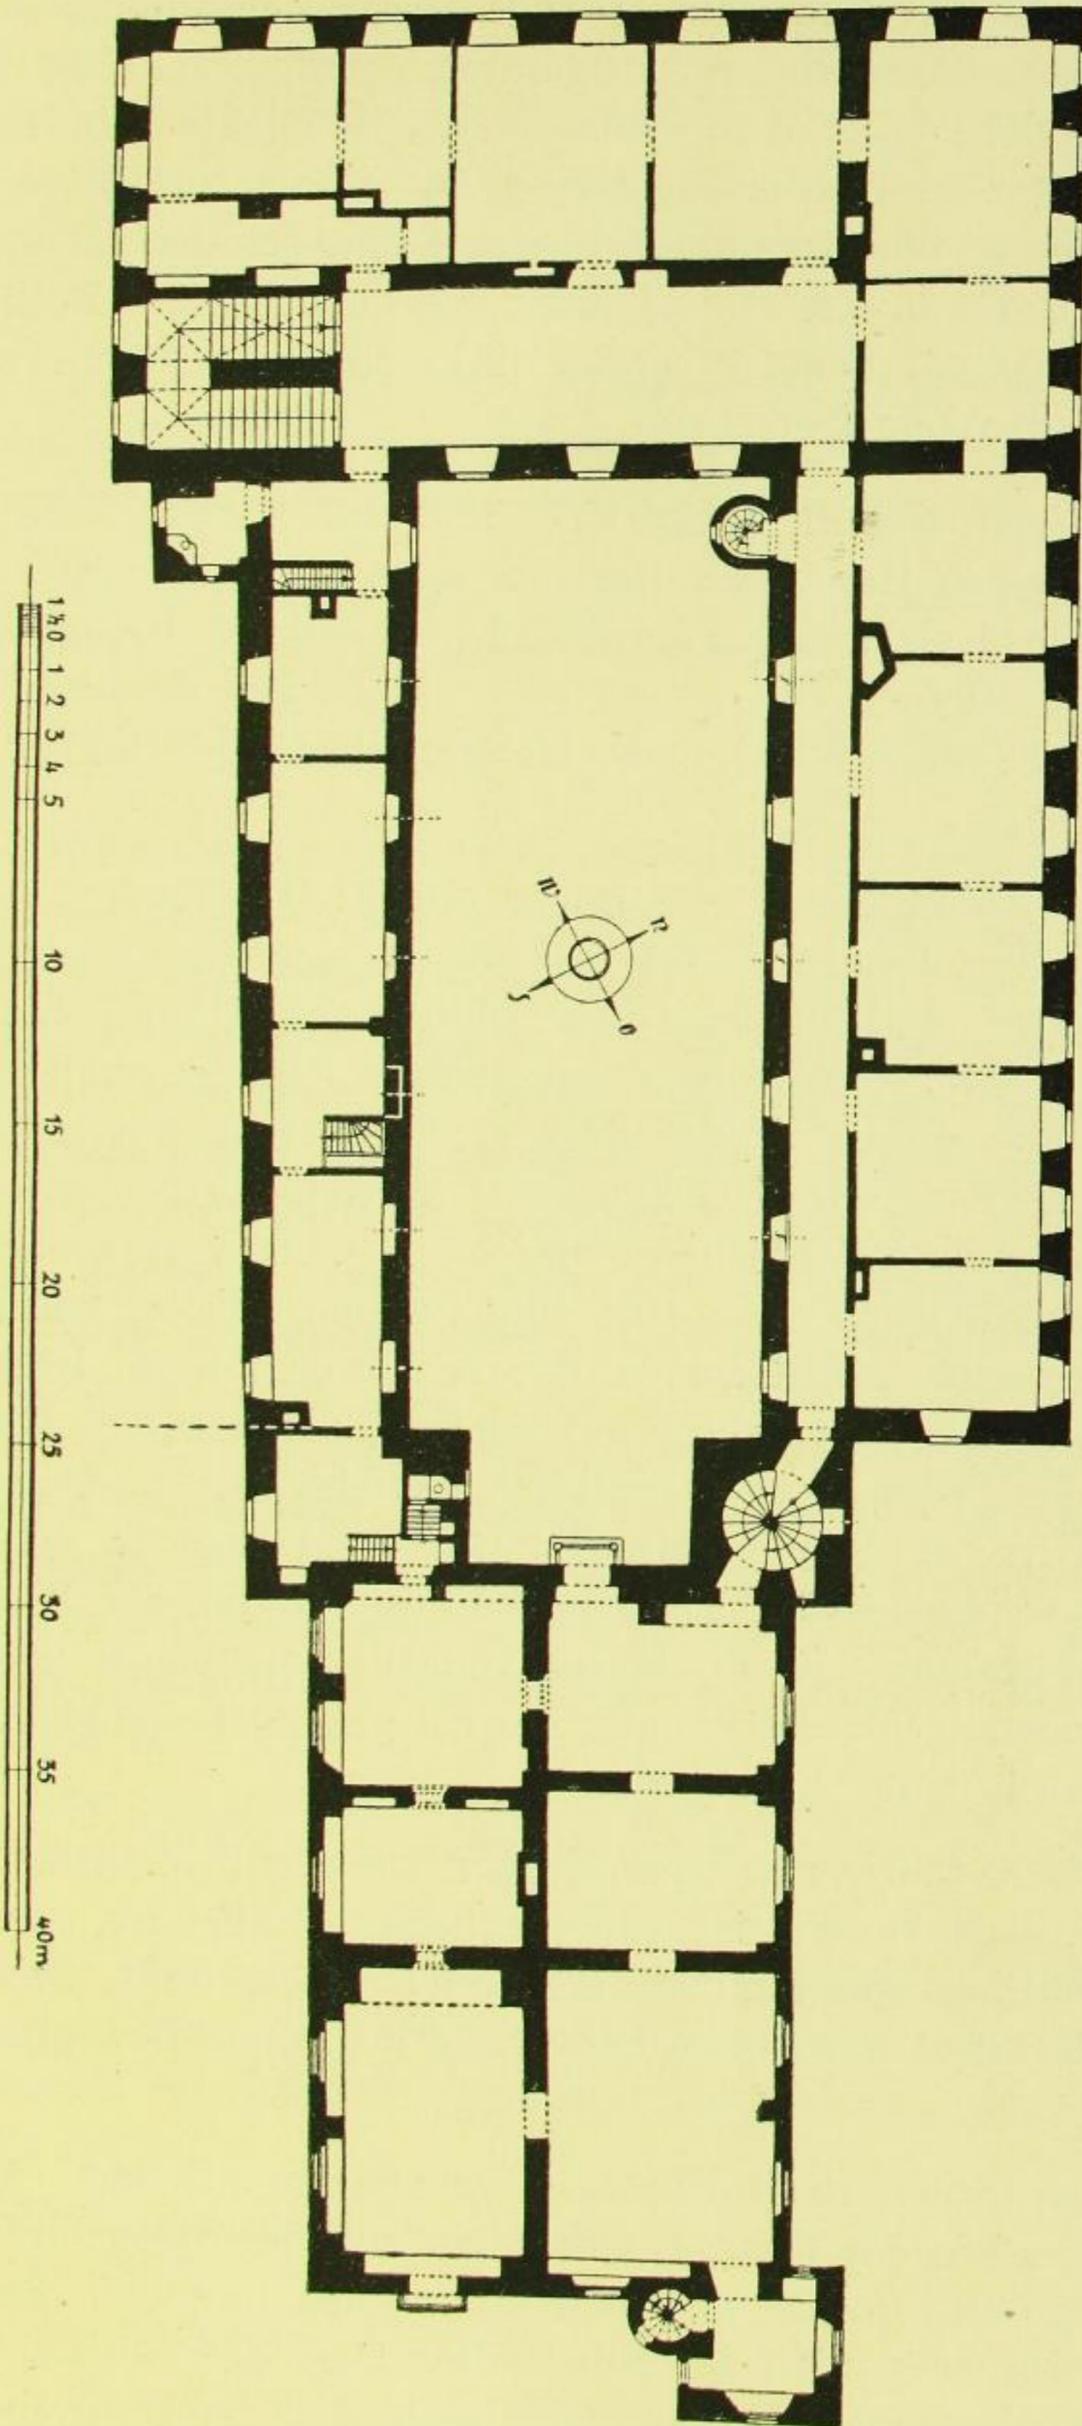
Schloß Siebeneichen, Grundriß des 1. Obergeschosses.
